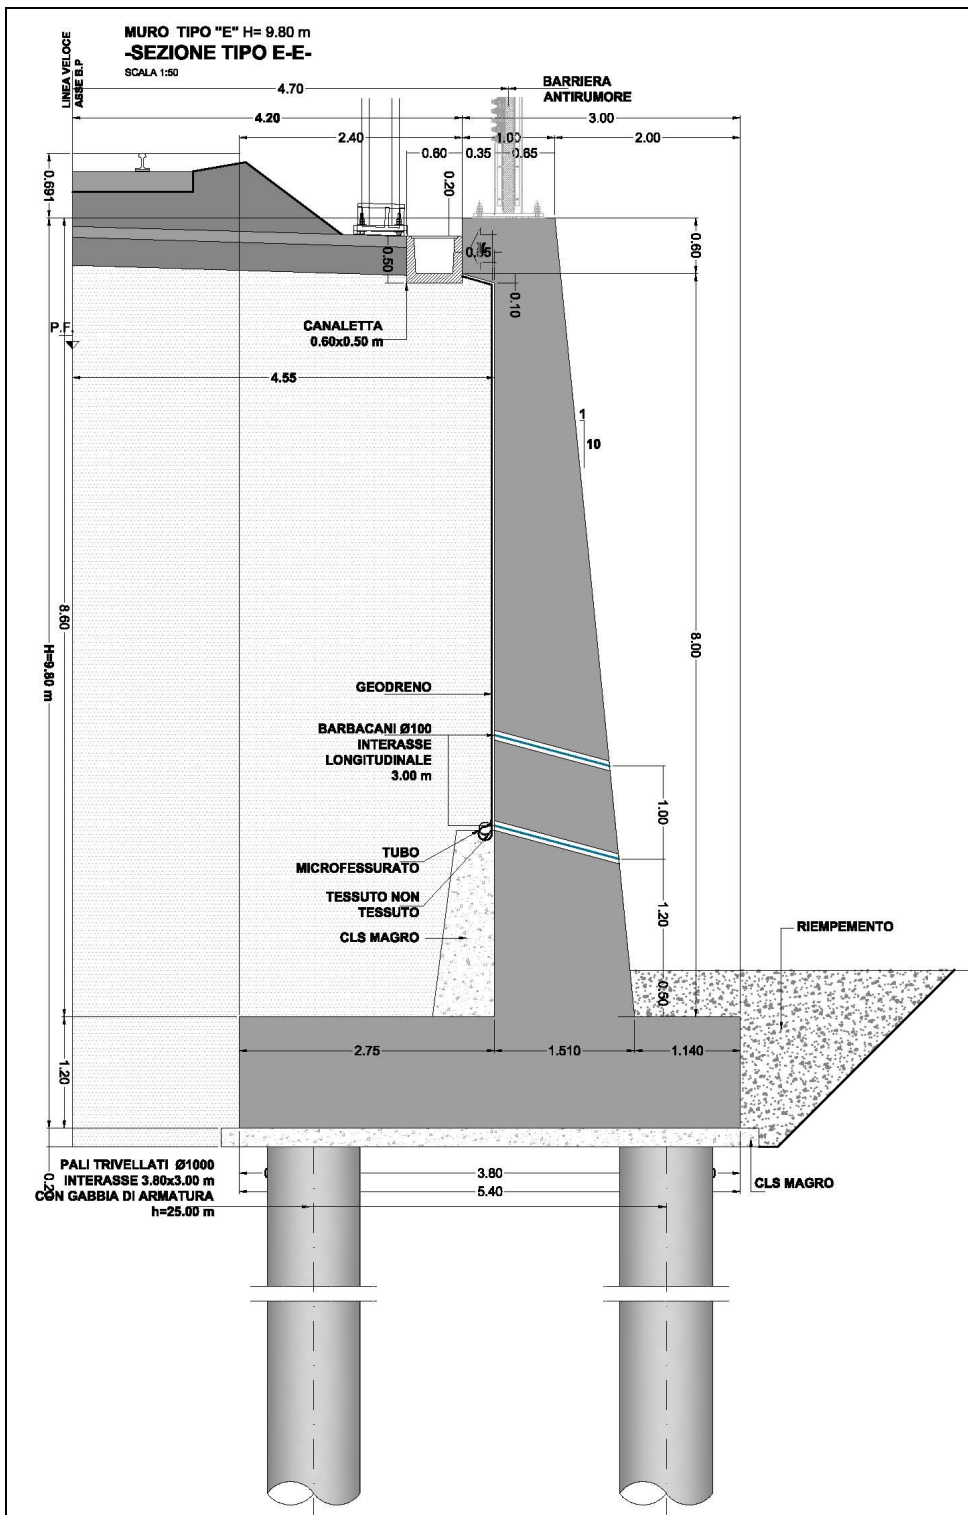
sezione di carpenteria del muro (altezza paramento= 8.60 m)
